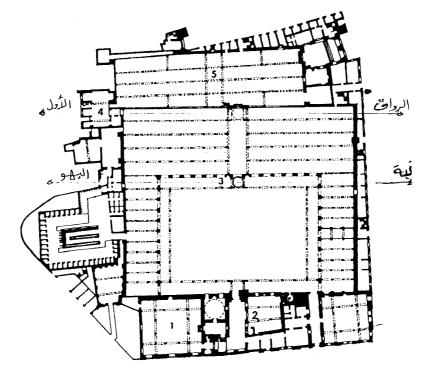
مسقط أفقي لمسجد القاضي يحيي زين الدين ببولاق بالقاهرة (عن ، هوتكيروفييت) .
